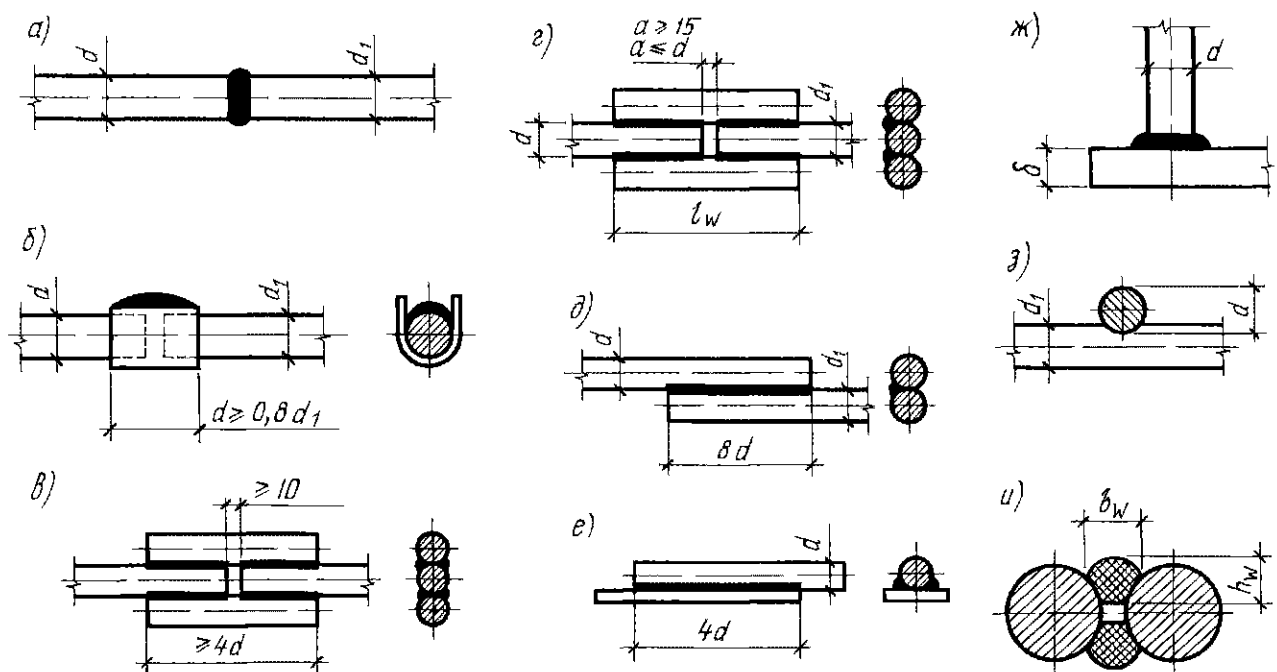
Сварные стыки ненапрягаемой арматуры
